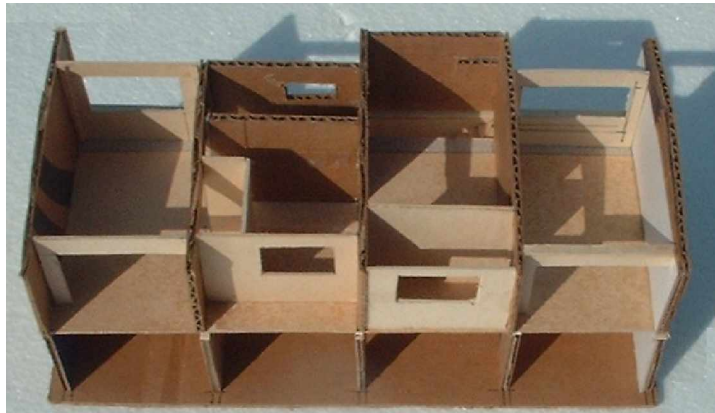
MAQUETA DE PLANTA ALTA
